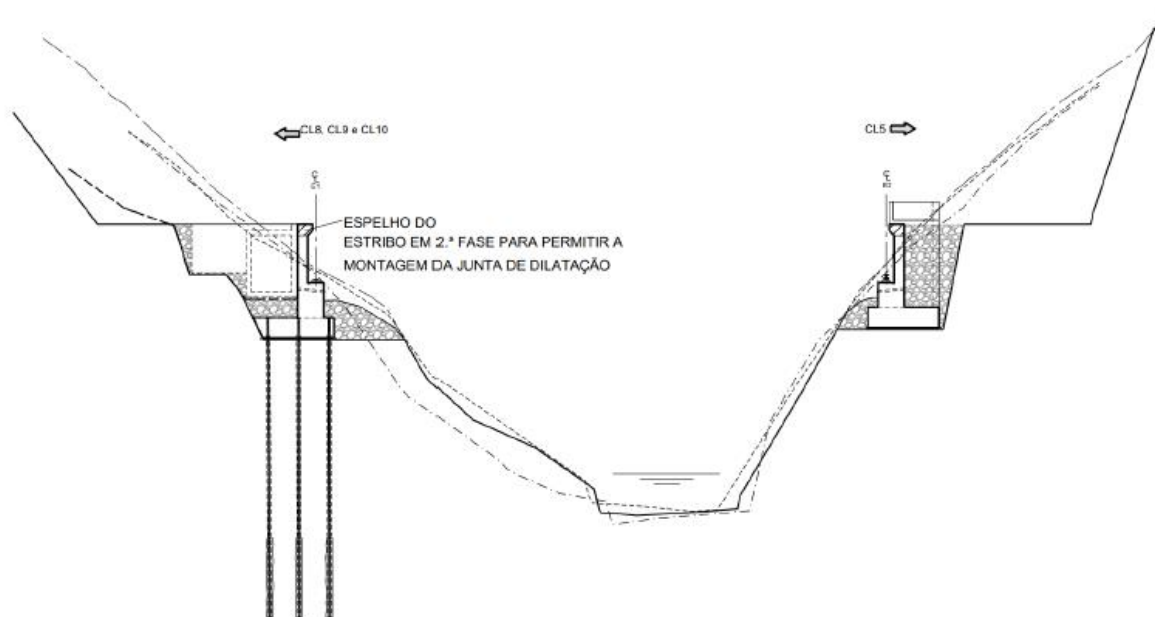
Fase III: Execução de aterros e preenchimento das escavações provisórias
